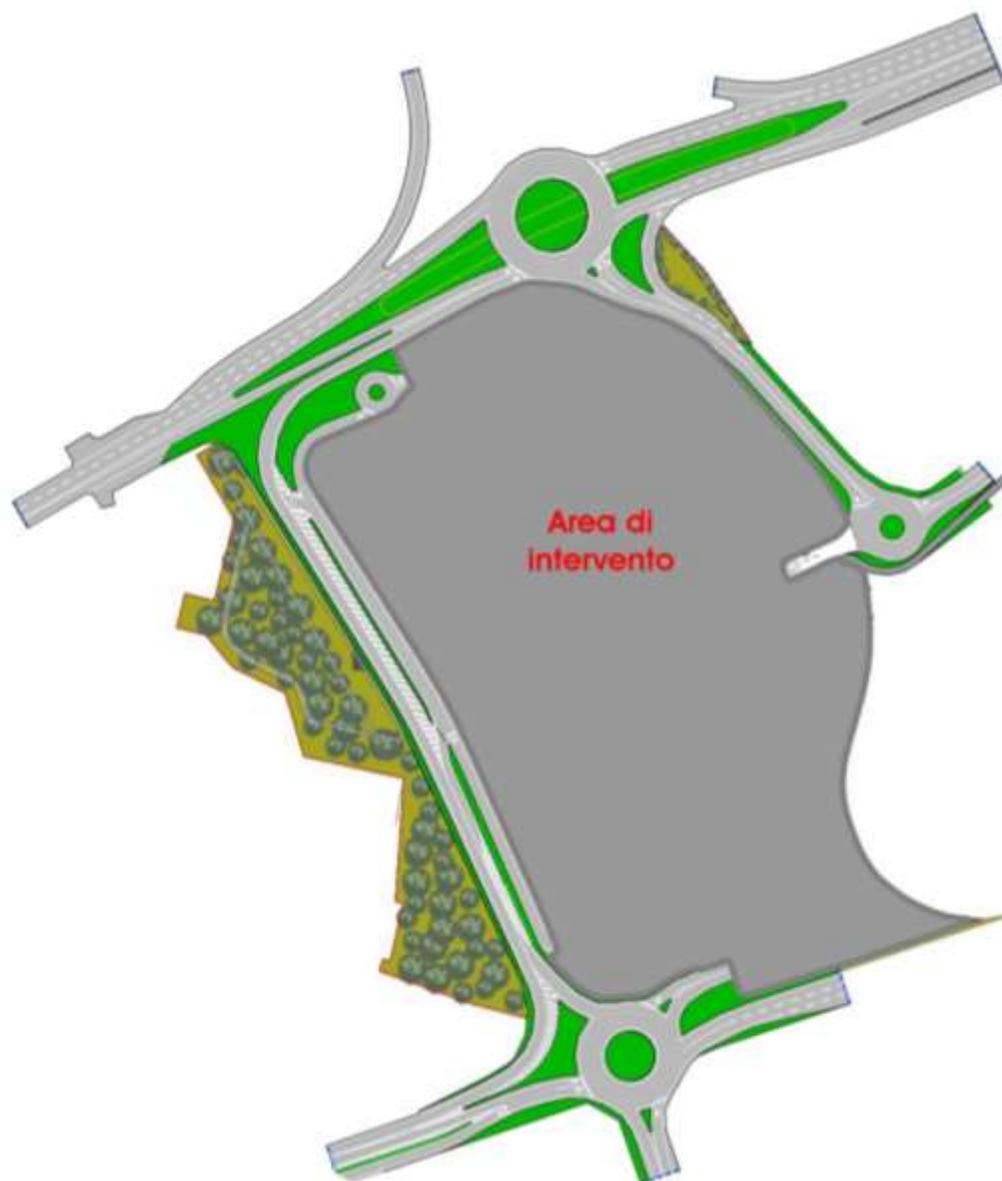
Interventi viabilistici previsti - Ipotesi 2 - Planimetria di progetto
